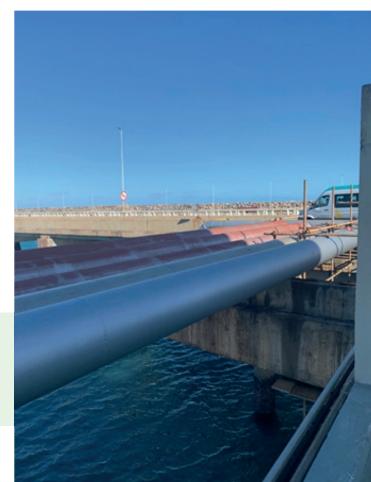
Exemplo de tubulação de GLP na interligação com pier
